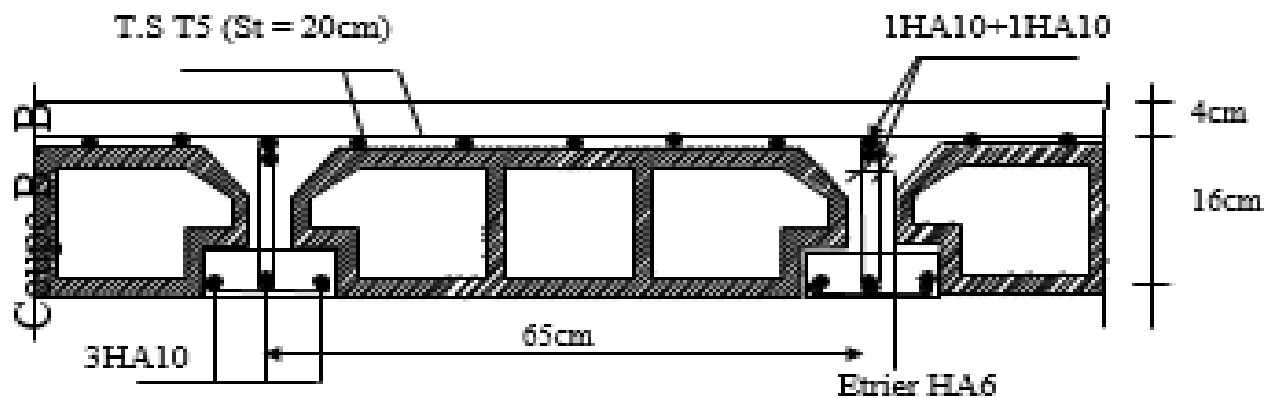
Plan de ferrailage du plancher aux appuis.
